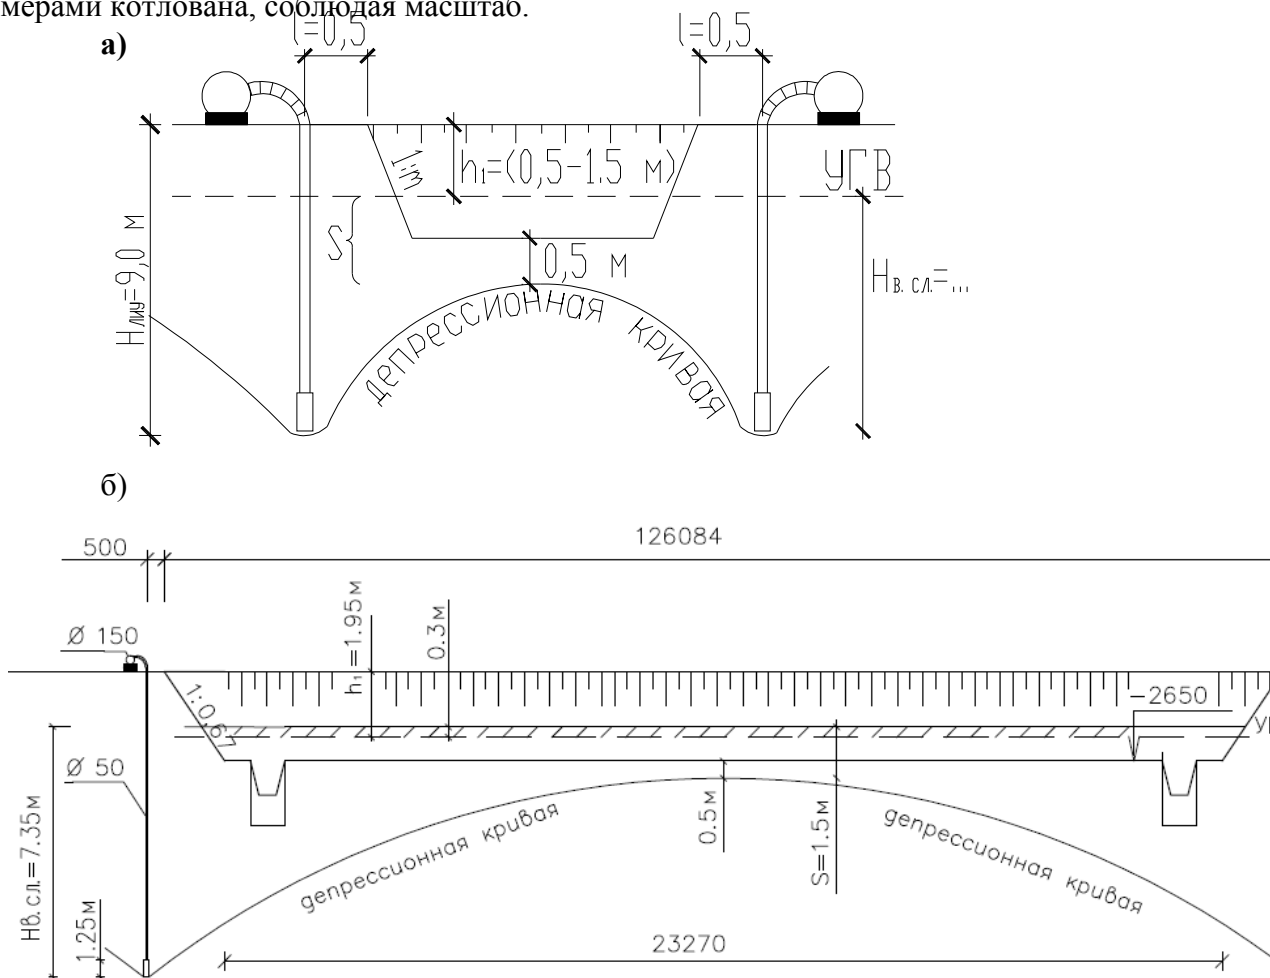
Расчетная схема размещения ЛИУ относительно котлована: а- условная расчетная схема (без системы водоотвода в основании выемки; б) расчетная схема разработана Снигиревой В.Н., гр ПГС-12-1).
